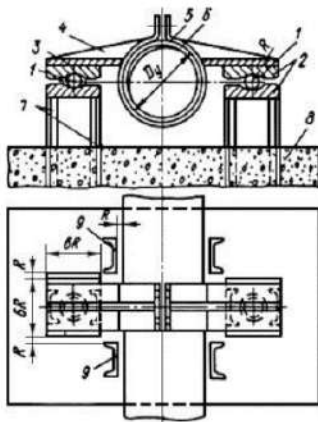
Схема оборудования водопровода греющим кабелем.
